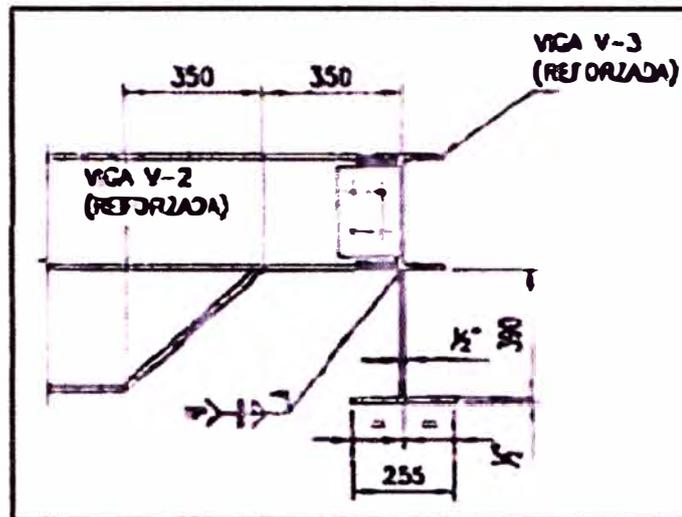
Corte para realizar el reforzamiento de la viga V-3
